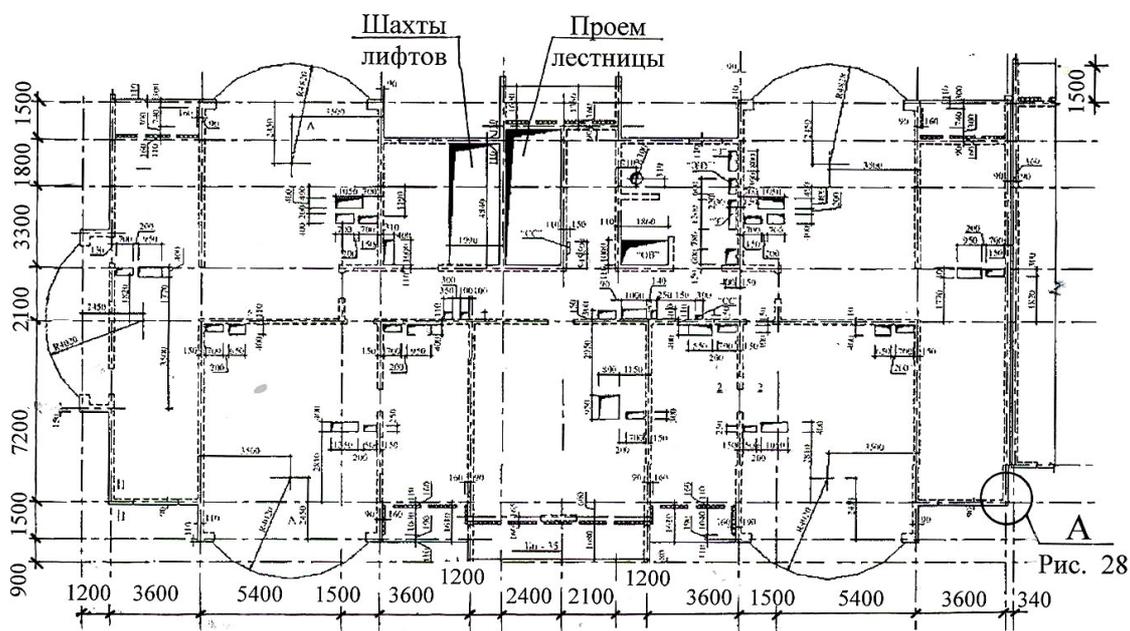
Пример плана монолитного перекрытия на отметке + 2,800
